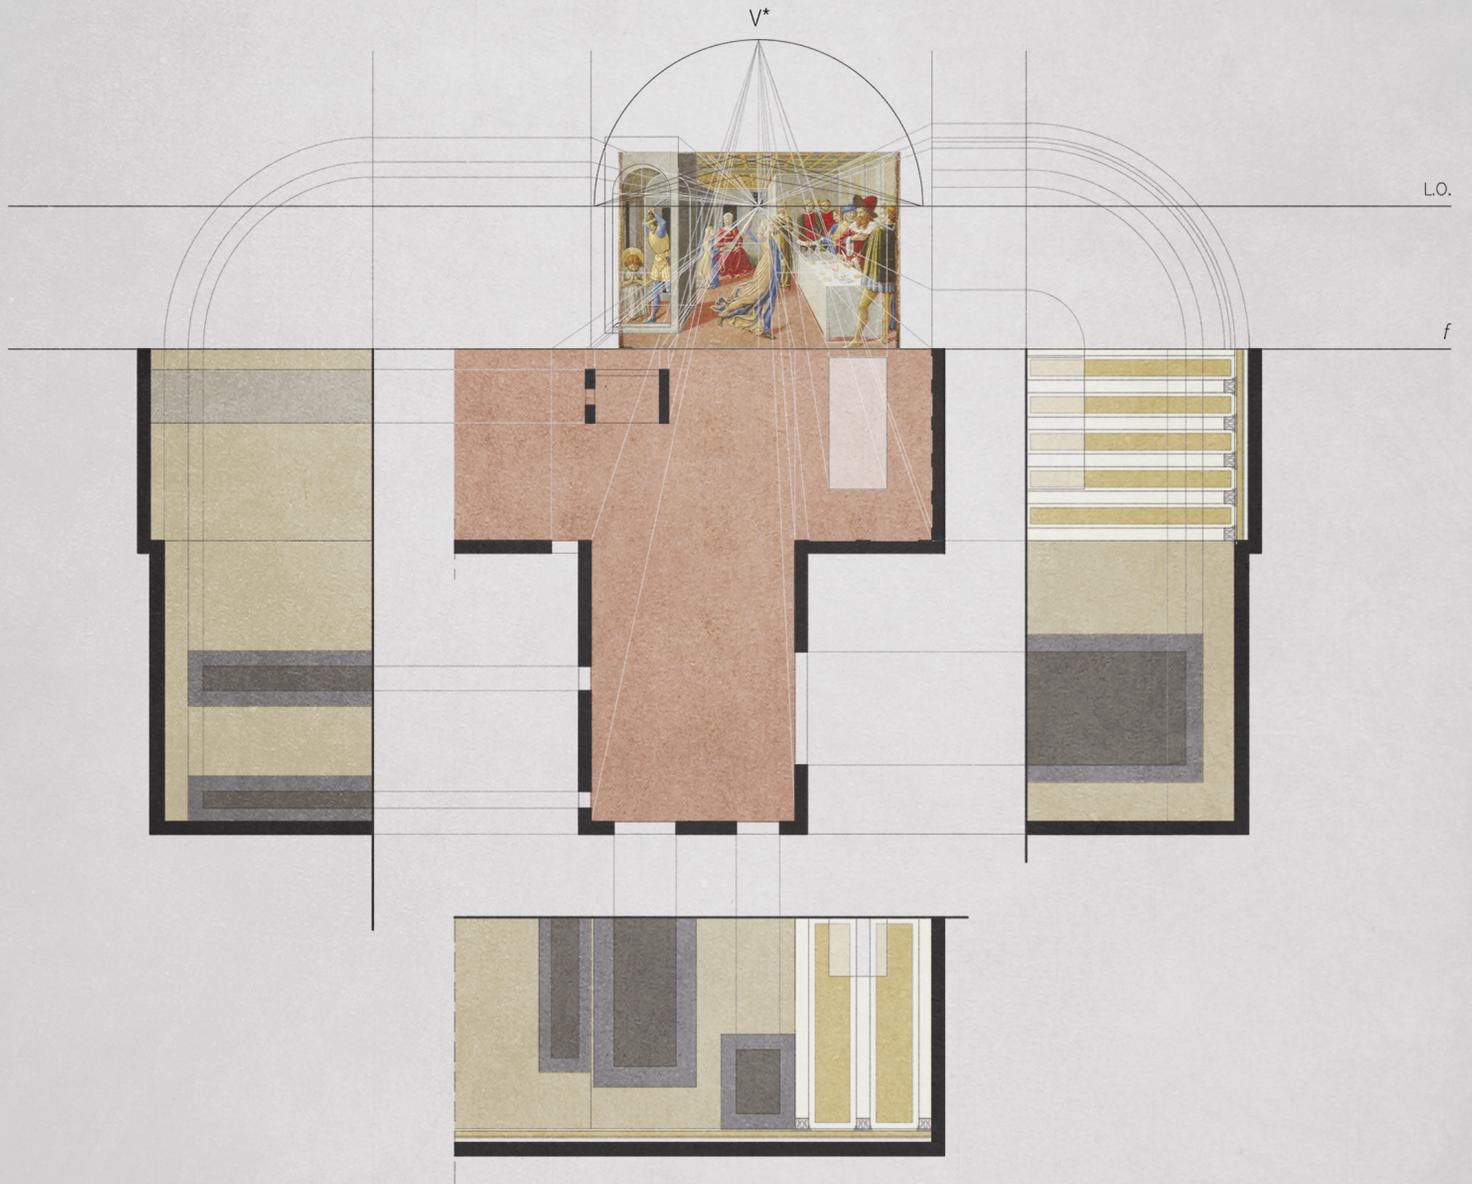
Restituzione prospettica di pianta e sezioni dello spazio dipinto.
